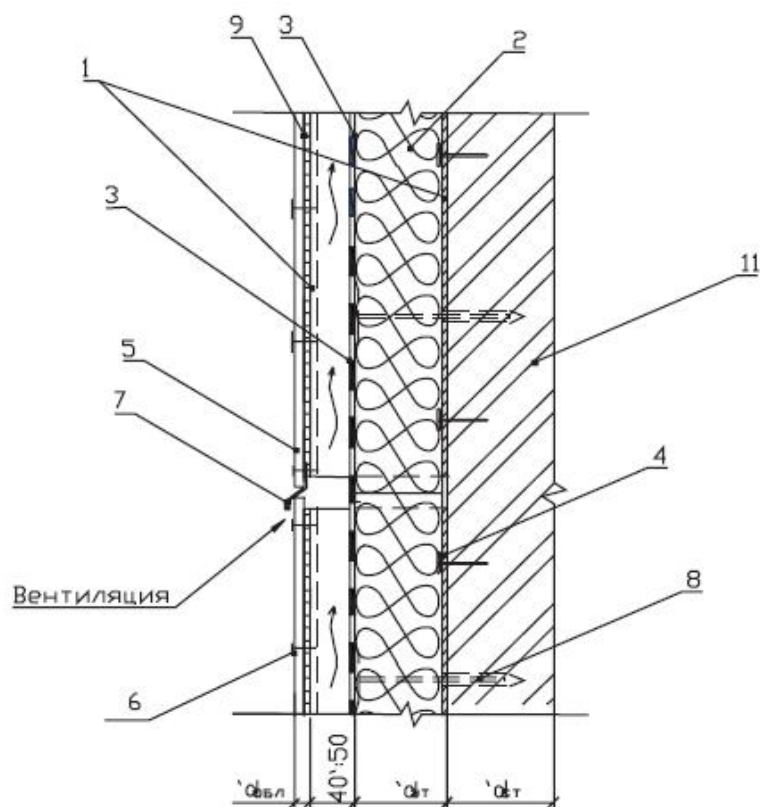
Утепление стены здания плитами марки «ТЕРМОВЕНТ» в конструкции вентилируемого фасада с защитно-декоративной облицовкой типа «siding» по металлической под облицовочной конструкции
